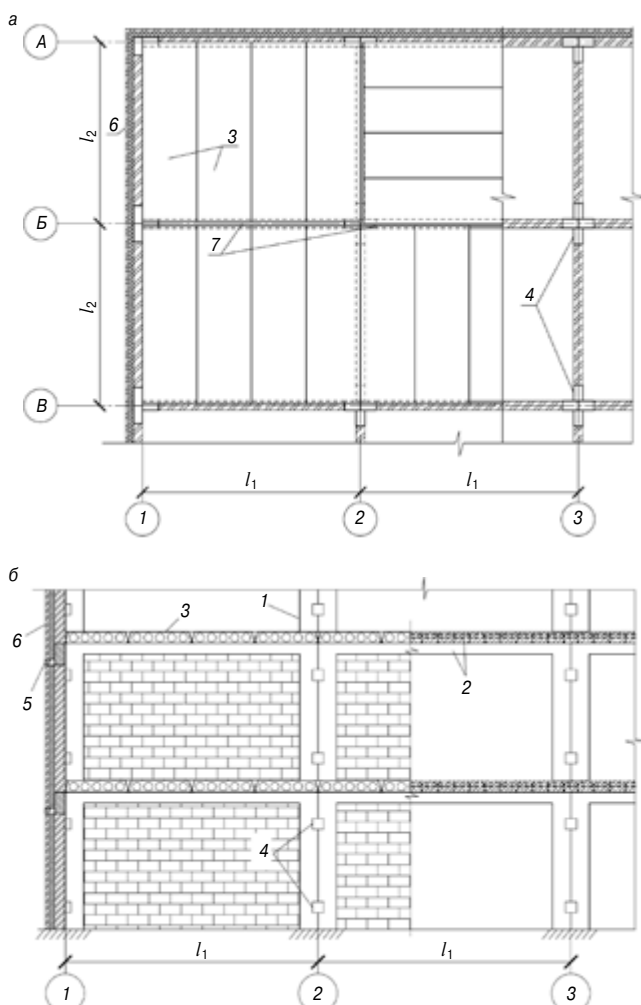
Схема горизонтальных (а) и вертикальных (б) связей в многоэтажном каркасно-панельном здании: 1 – стойка панели рамы; 2 – сборно-монолитный ригель; 3 – панель перекрытия; 4 – вертикальные связи; 5 – обвязочный ригель; 6 – наружная стена; 7 – горизонтальные связи в плоскости перекрытия
